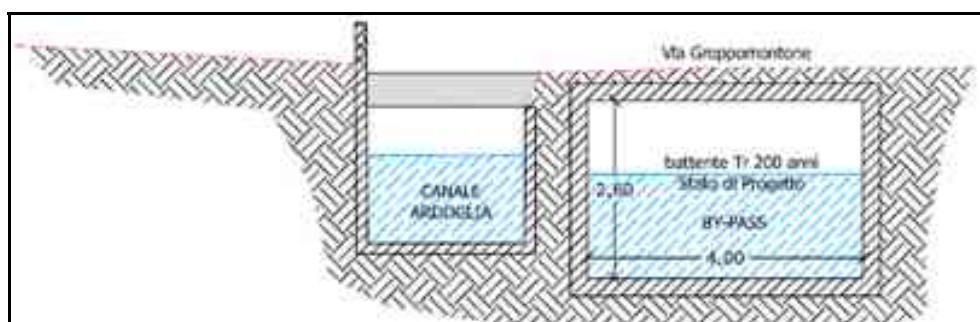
Particolare della sezione di monte del ponte estratto dalla tavola allegata
